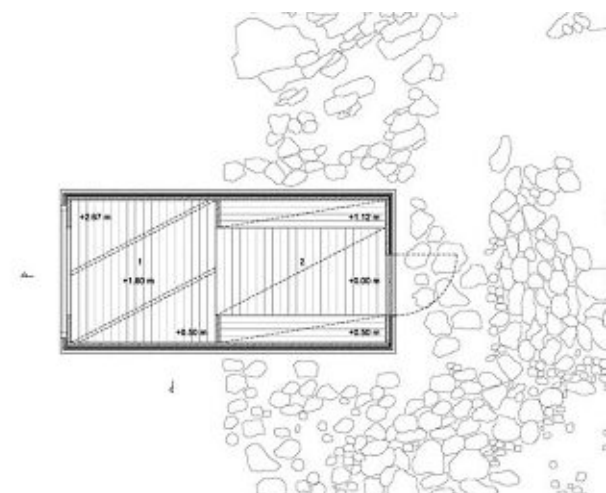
47 Grundriss Biwakschachtel MK
